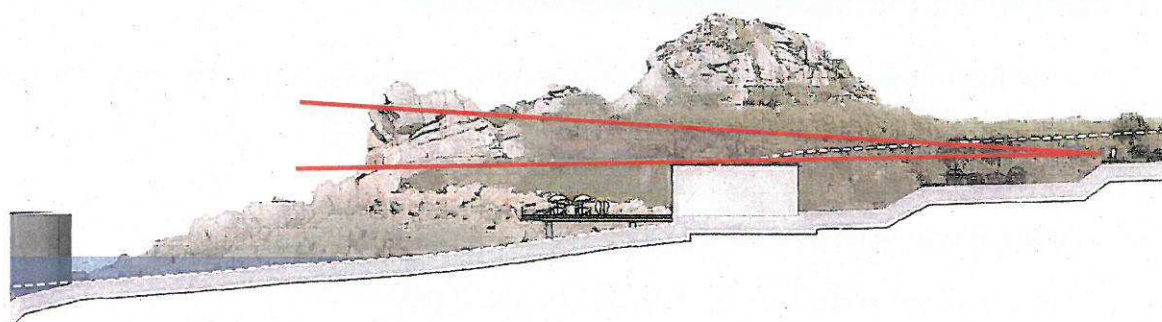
coupe de principe - Implantation des bâtiments de commerces en secteur 1NAPa (source : schéma directeur – J-F. Revert)
